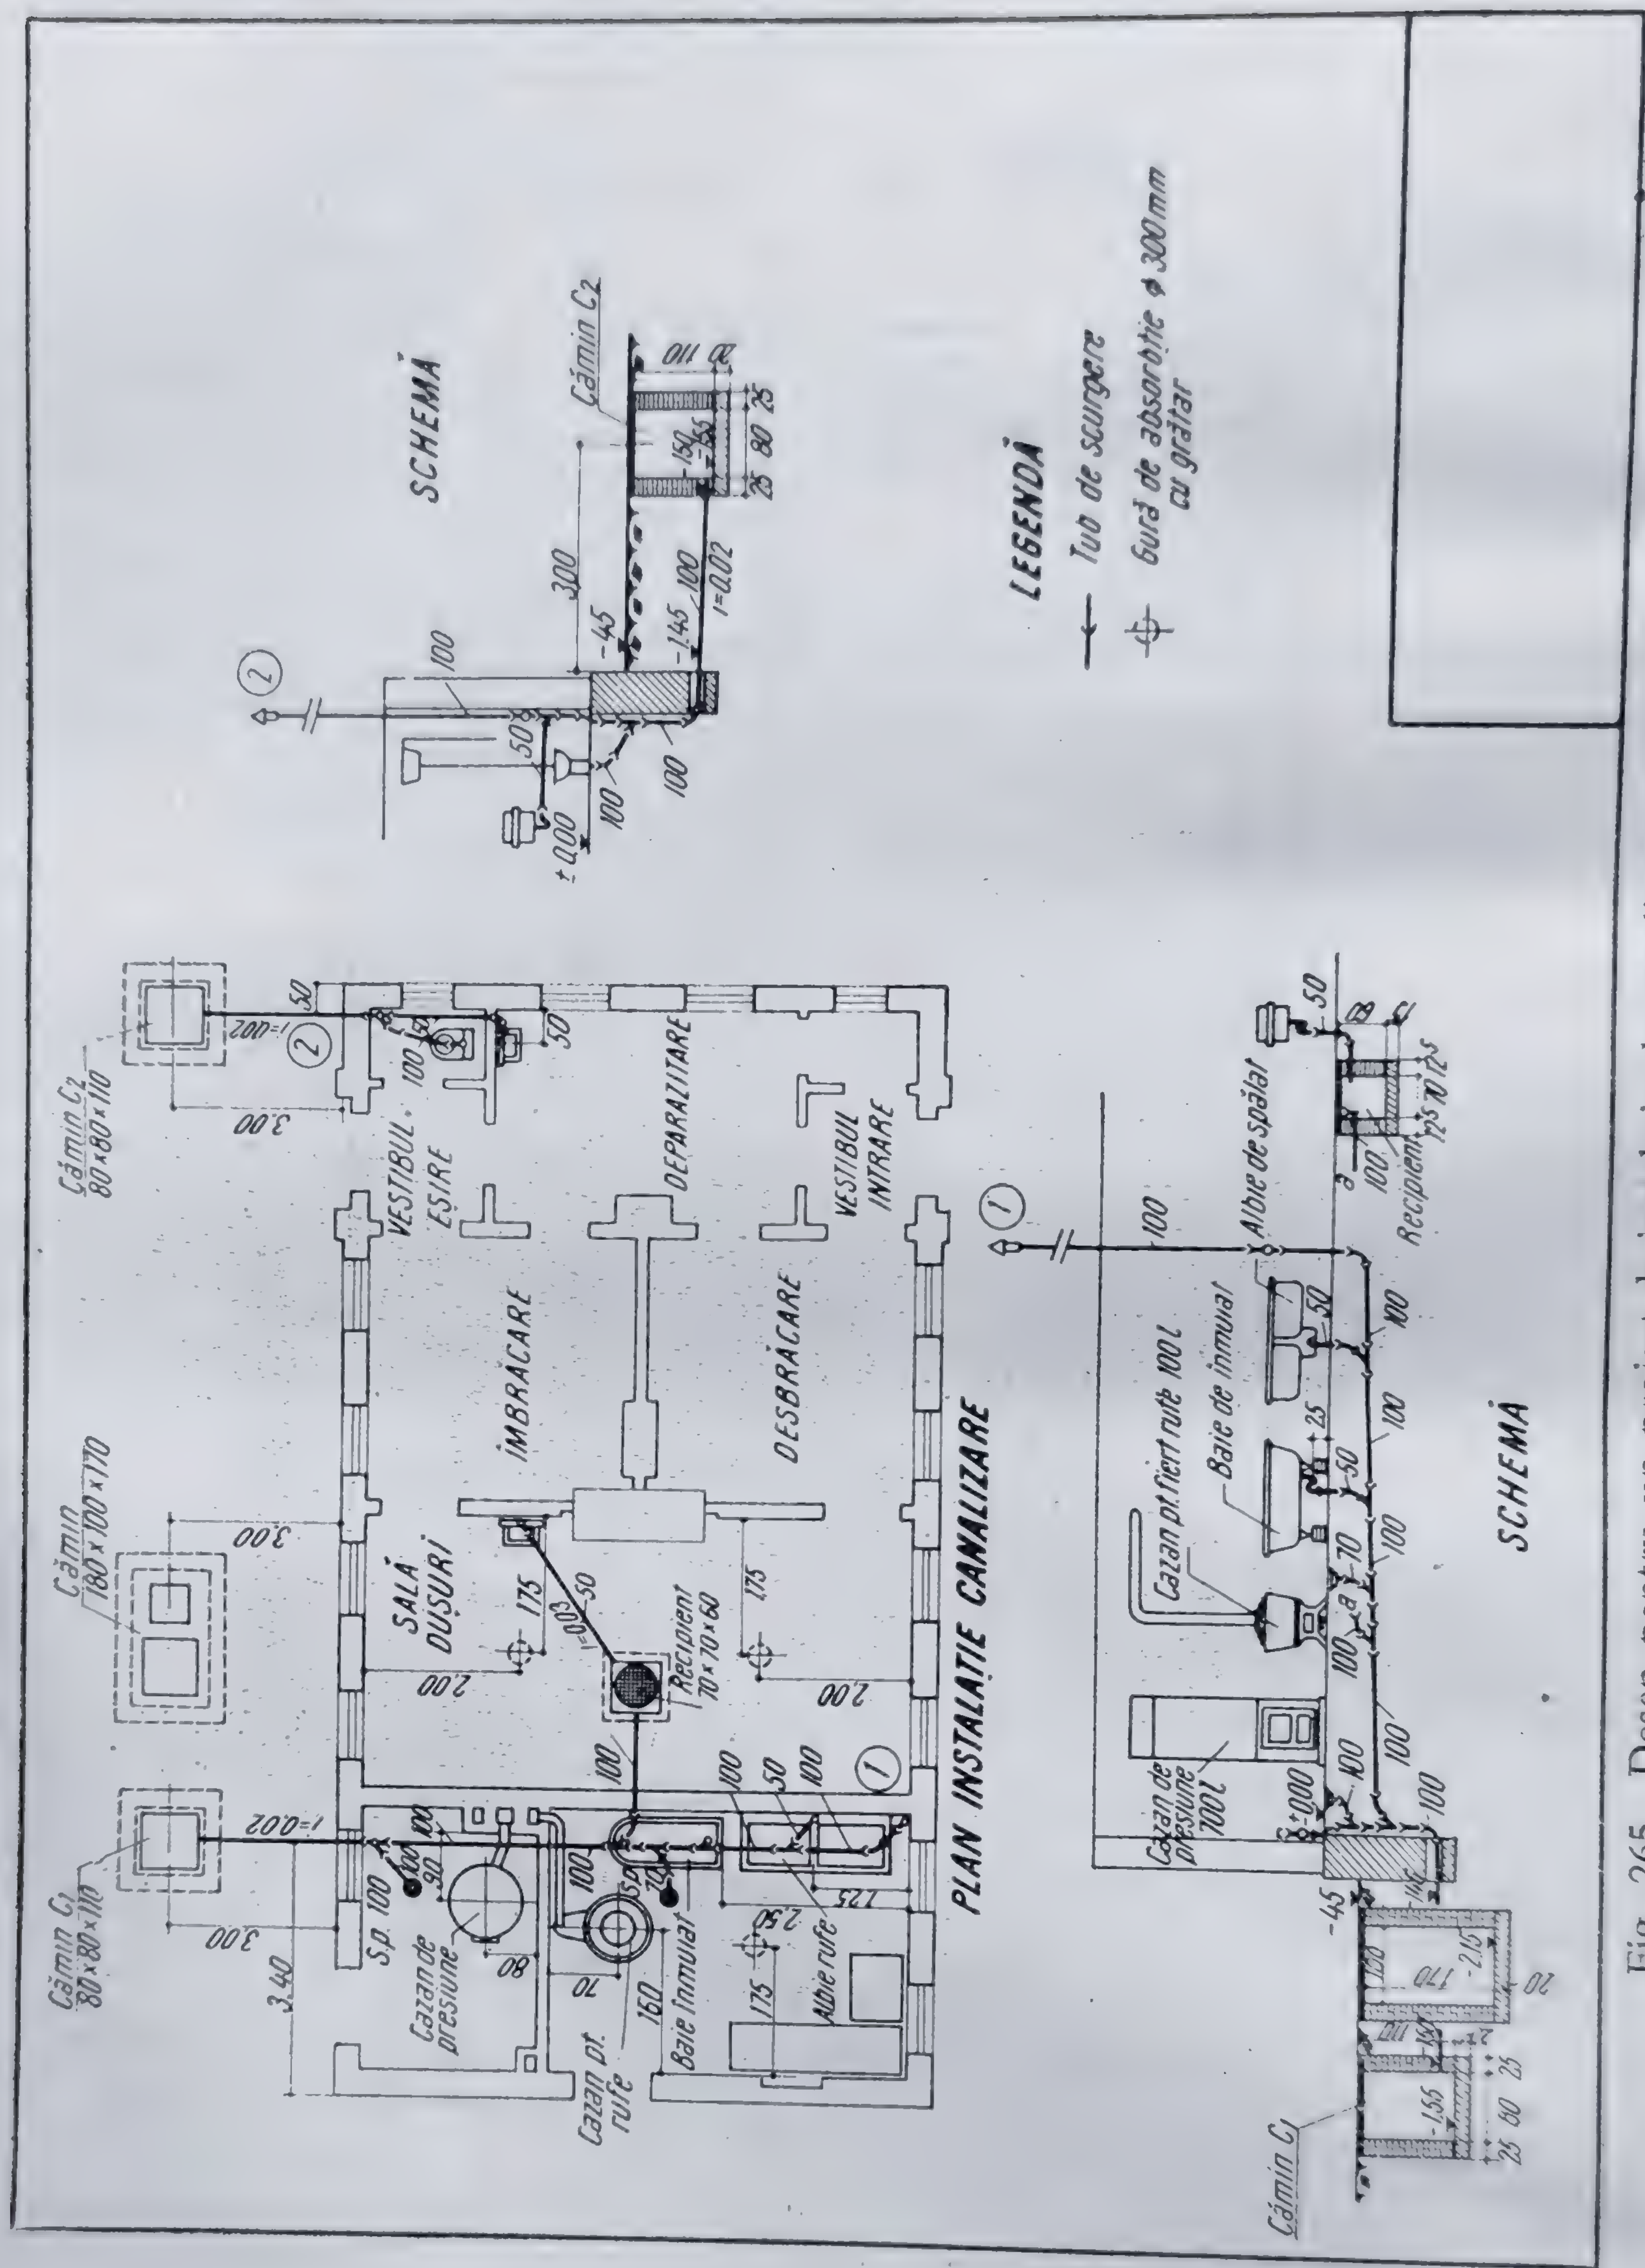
Desen pentru un proiect de instalație de canalizare interioară. Plan și scheme.
